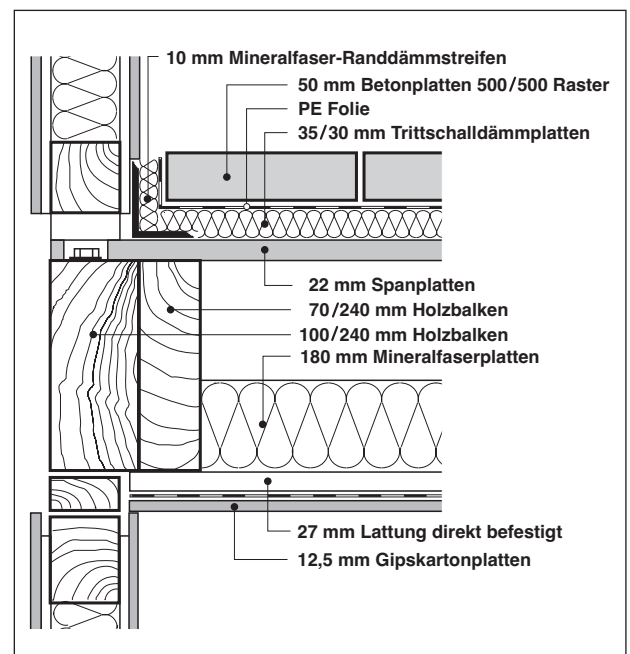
Detailzeichnung der Deckenkonstruktion mit einem elementierten schwimmenden Estrich und der Anbindung an die Wände im Holzbau-Prüfstand
